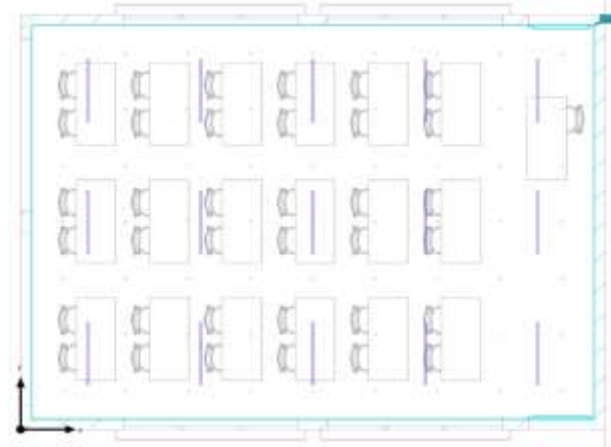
Cantidad y disposición de luminarias en planta baja. Fuente: DIALux Evo. (DIAL GmbH, 2024)
